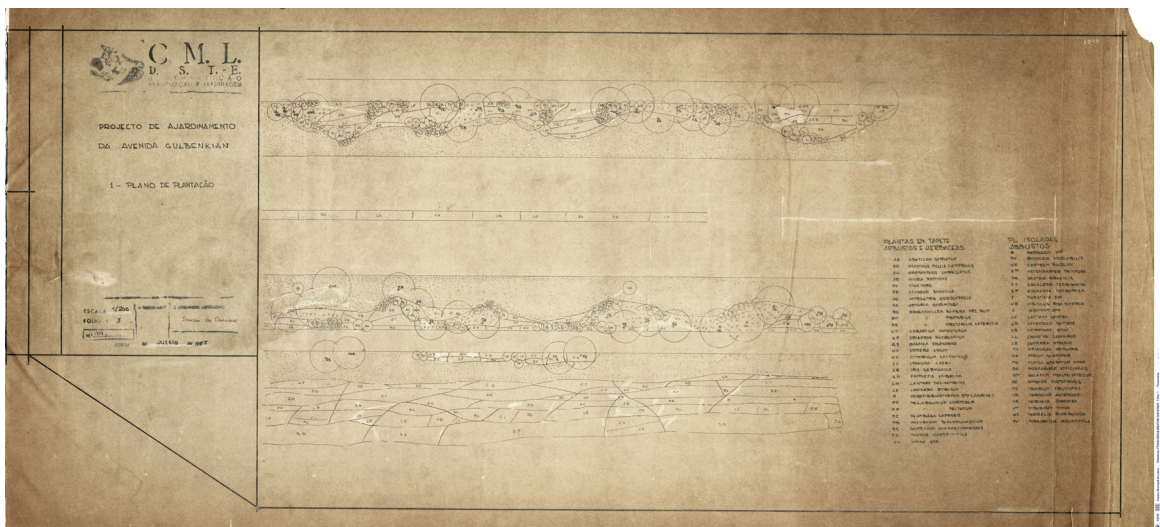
Projeto de ajardinamento da Avenida Gulbenkian. Plano de plantação, Sousa da Câmara, 1967.
